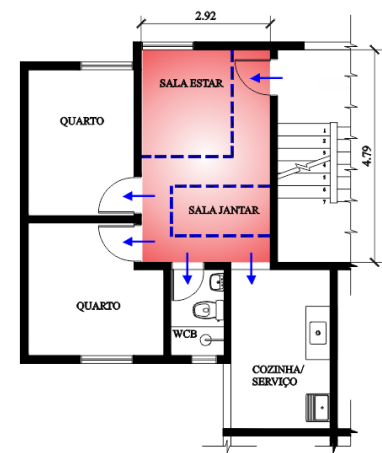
Planta Baixa Pav. Tipo: Setor Social do Residencial José Bernardes (sem escala)
